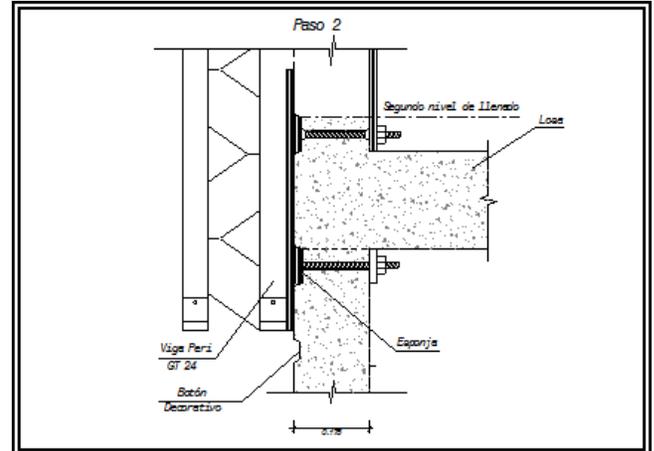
Placa de moldaje con botones decorativos y canterías para tratamiento de junta de construcción en hormigón arquitectónico, marcando con una doble cantería en la cabeza de la losa. (Edificio Fac. de Medicina Universidad de La Frontera) (Autor)
